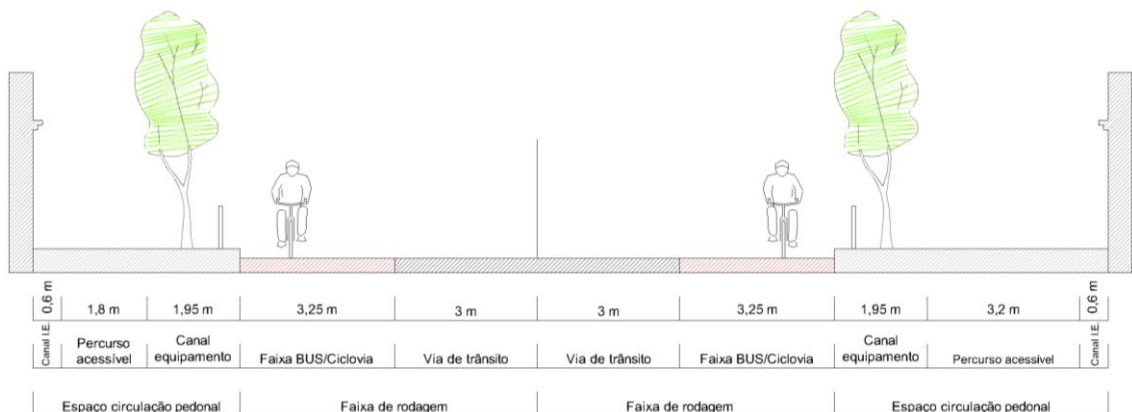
SECÇÃO PROPOSTA N-N'
